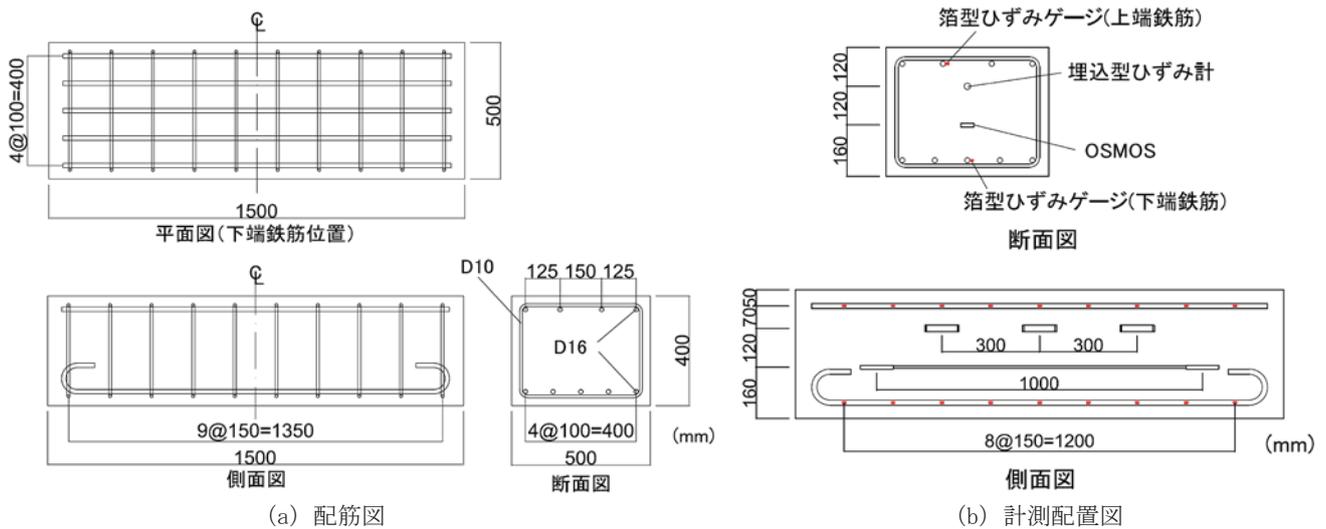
試験体の形状寸法，配筋概要および各種計測機器の配置位置
